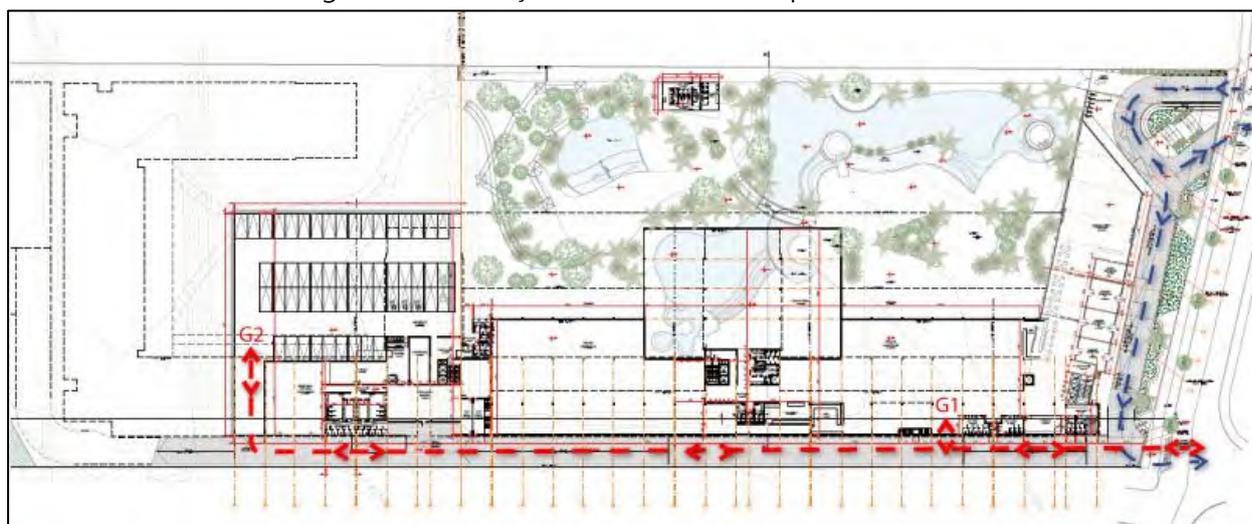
Acesso 2: garagem, estacionamentos e carga/descarga
